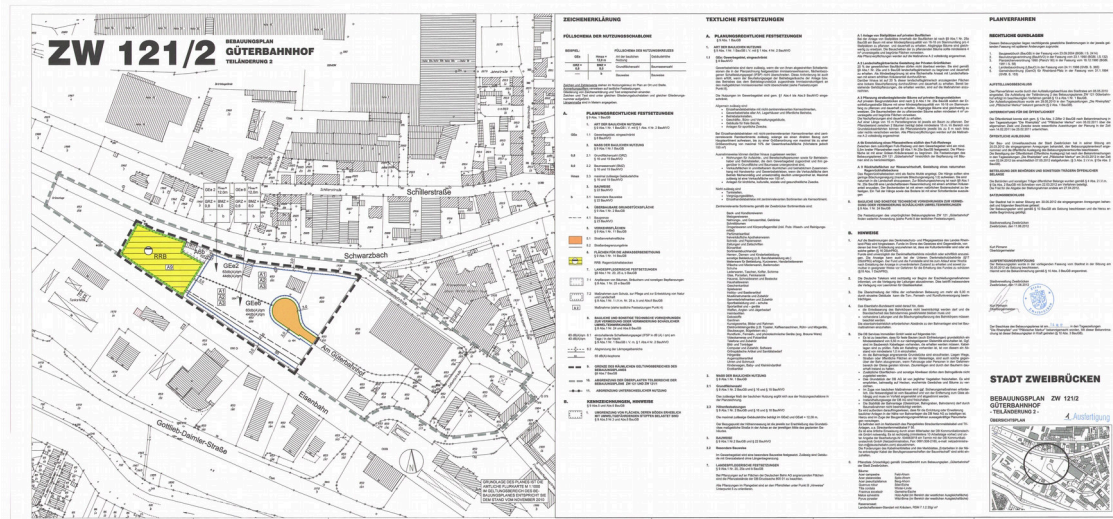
Bebauungsplan Güterbahnhof Teiländerung
